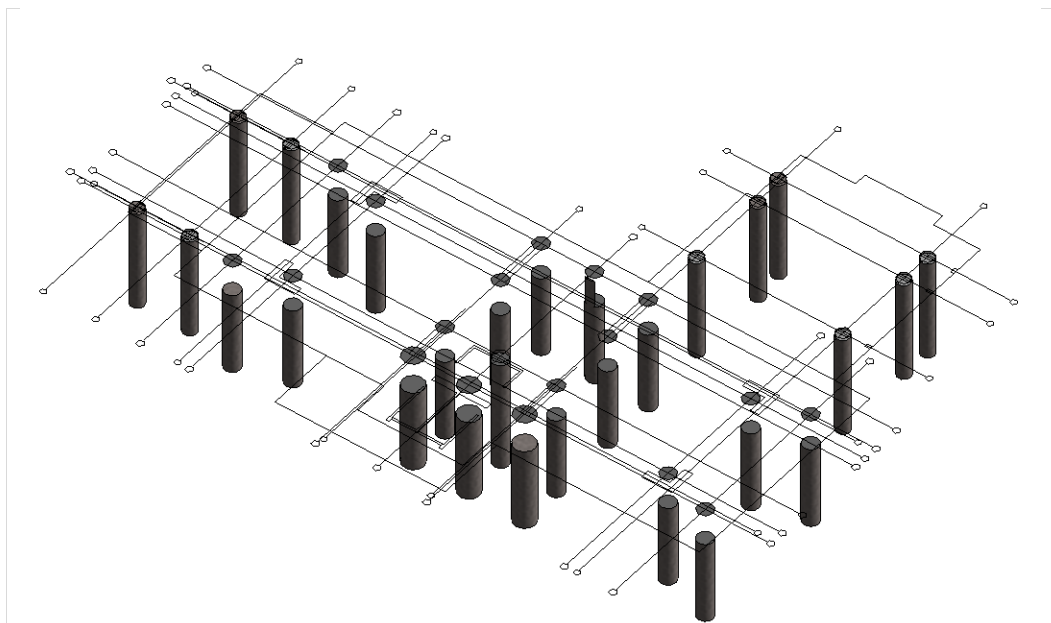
Proceso de ubicación de las pilas según plano de cimentaciones.
